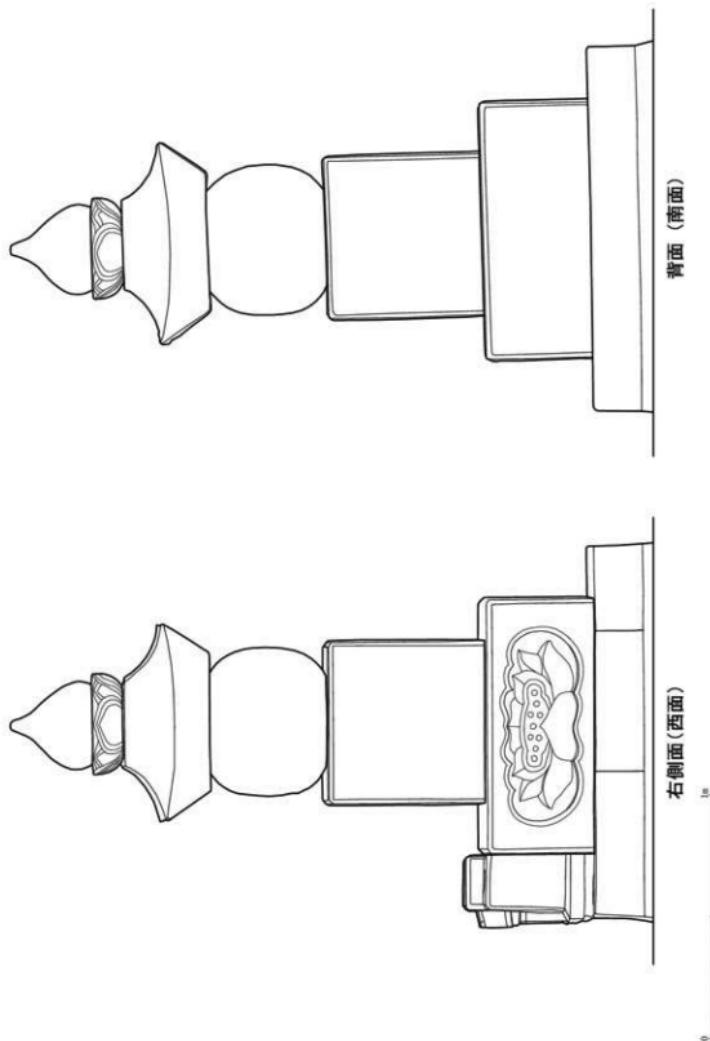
4 1号墓 5代当主岛津忠刚墓石立面图 (S = 1/20)
